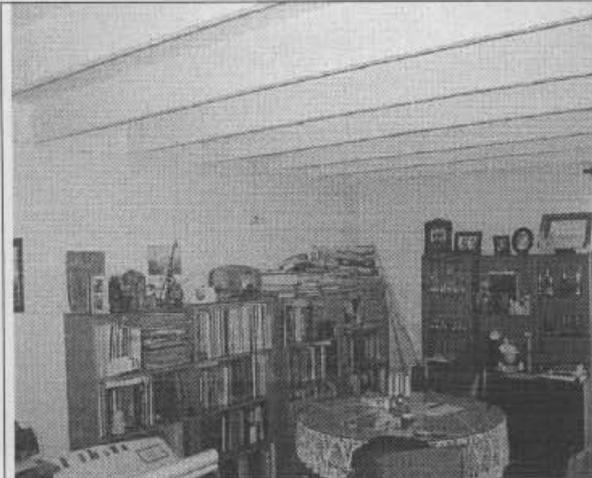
Vista de sala comedor, sin daño estructural aparente.
